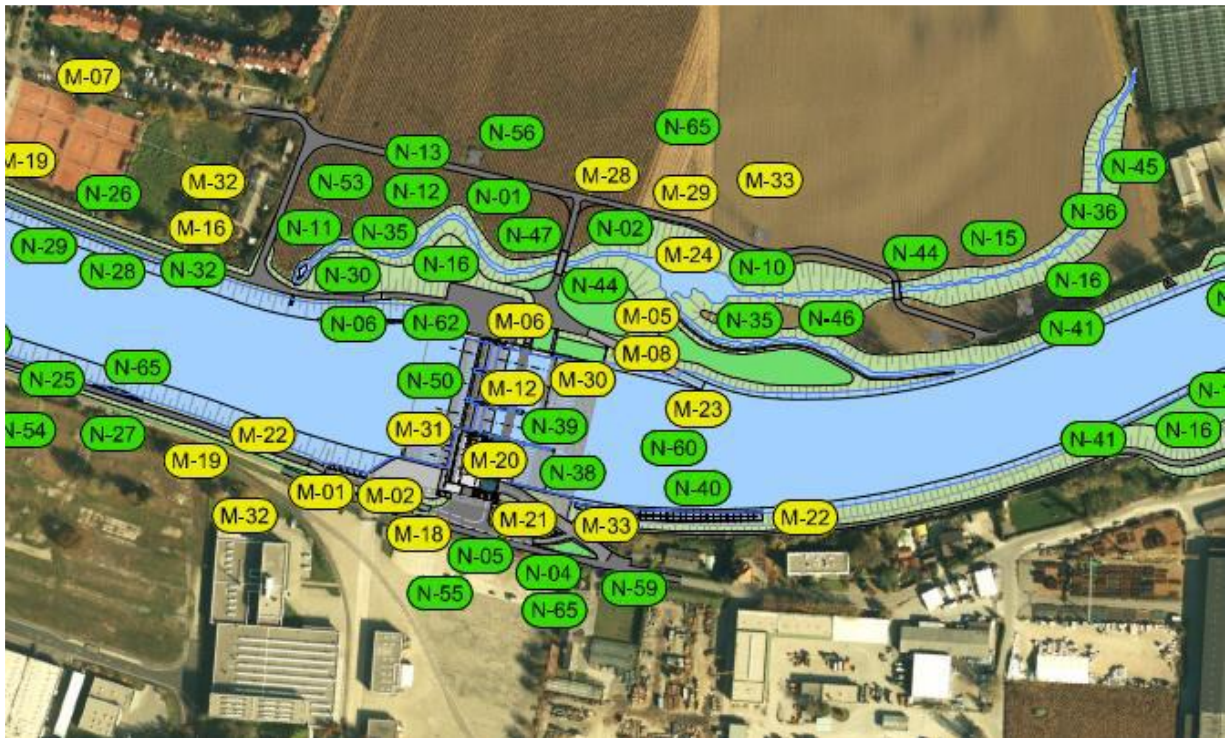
Lageplan Maßnahmen Einreichprojekt (s.M-22)
